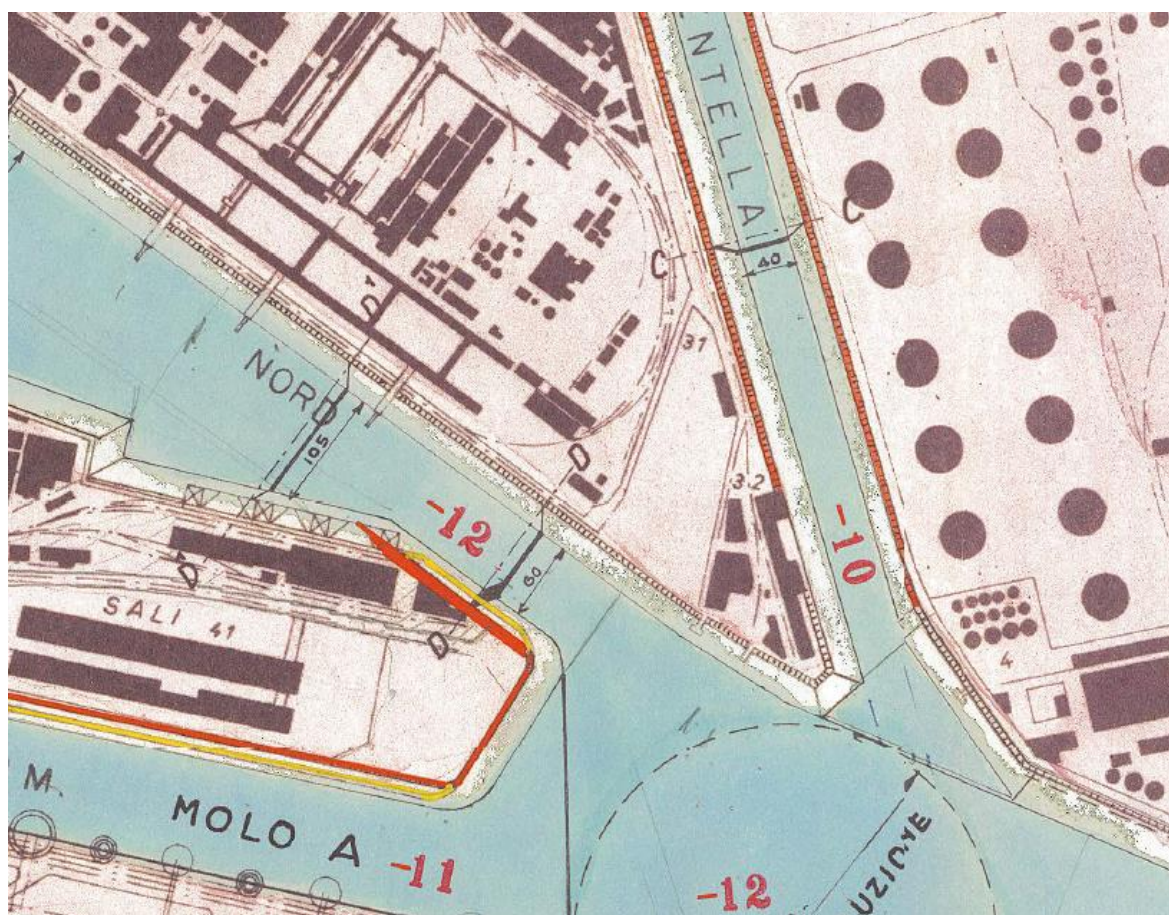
Planimetria PRP vigente con evidenziata le sezioni D-D e D'-D' (Canale Industriale Nord) in prossimità della banchina ex italiana Coke e sezione C-C (Canale Industriale Brentella).
